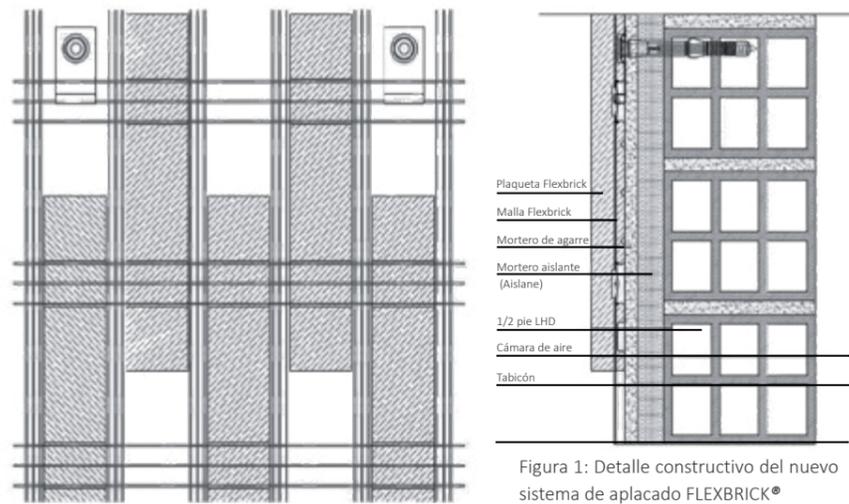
Detalle constructivo del nuevo sistema de aplacado FLEXBRICK®
